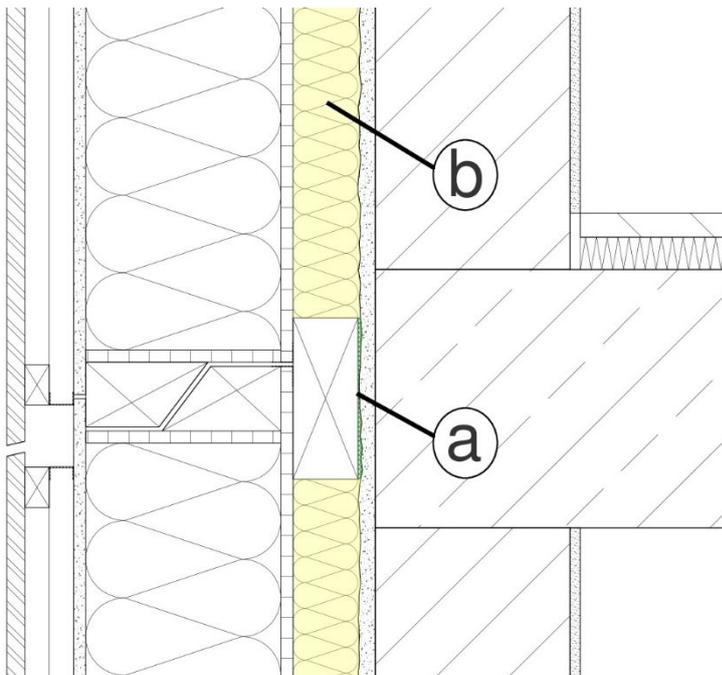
Ausgleich der vorhandenen Toleranzen am Bestandsgebäude (a) Die Montagebalken werden durch Abstandhalter ausgerichtet (b) Der verbleibende Hohlraum wird vor Anbringen der Elemente mit Mineralwolle gefüllt
